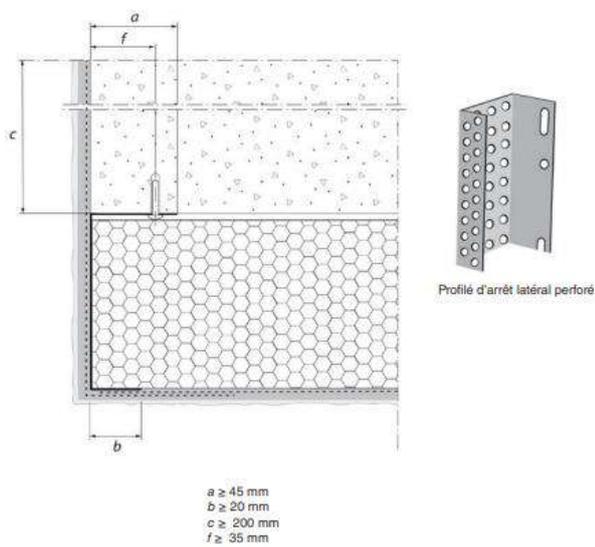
Arrêt latéral en angle sortant variante 1 (recouvrement d'armatures ; coupe horizontale)
